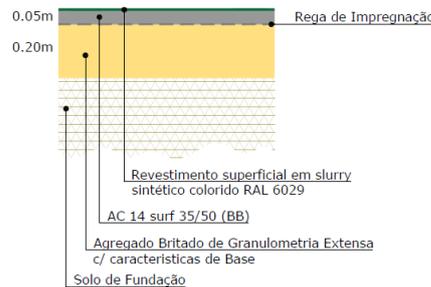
Estrutura de pavimento proposta para ciclovia ao nível do passeio
